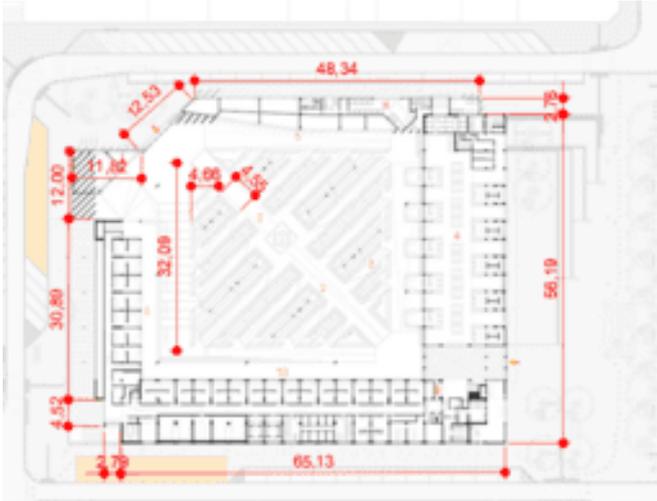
Planta primeiro pavimento com levantamento métrico.
